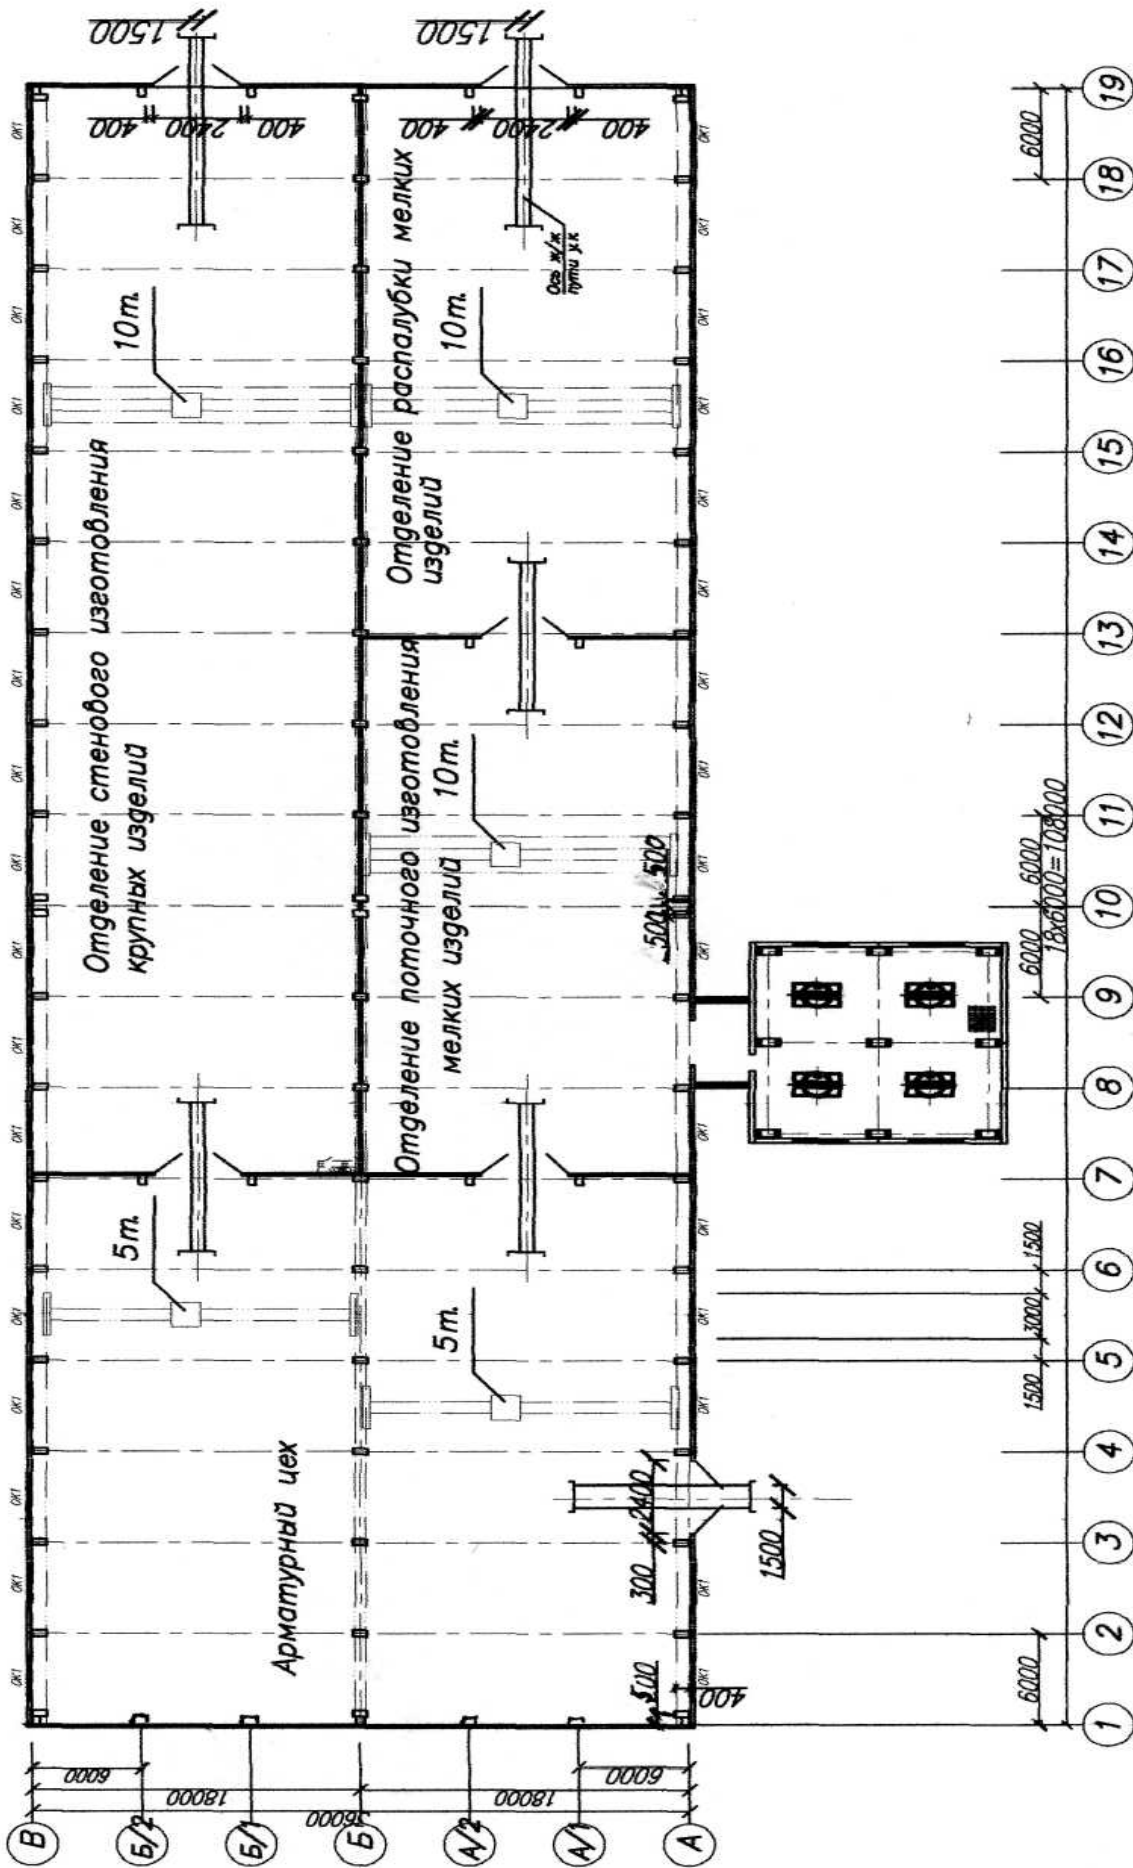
Пример выполнения плана производственного цеха завода железобетонных изделий
